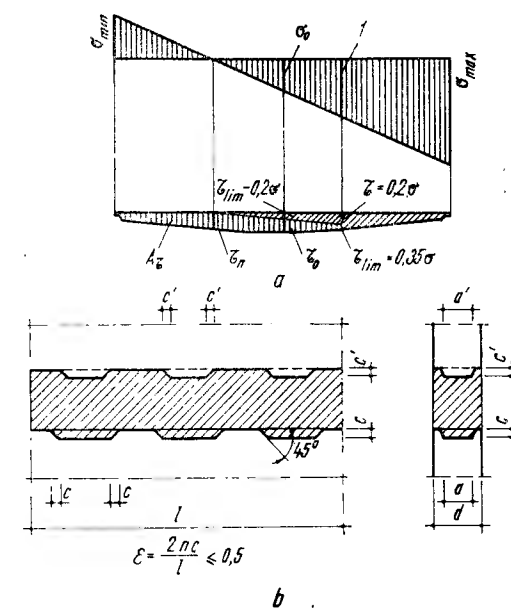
Îmbinare orizontală cu subbetonare :
